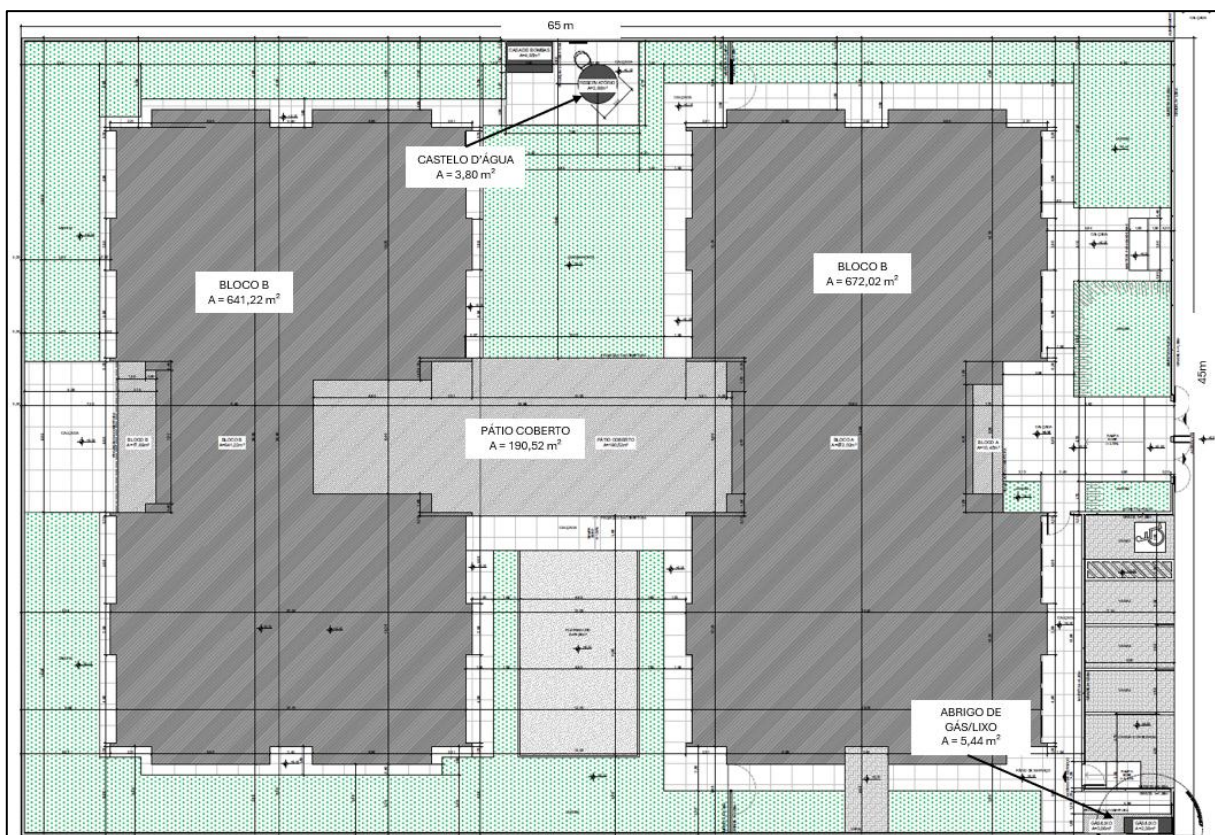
Planta de Arquitetura (TIPO 1-ARQ-IMP-GER-01_R03)
